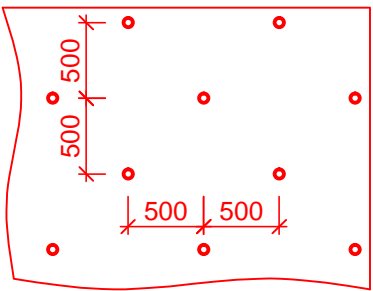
(DETAIL ULOŽENÍ PROTIEROZNÍ ROHOŽE POD KAMENNÝ POHOZ)
